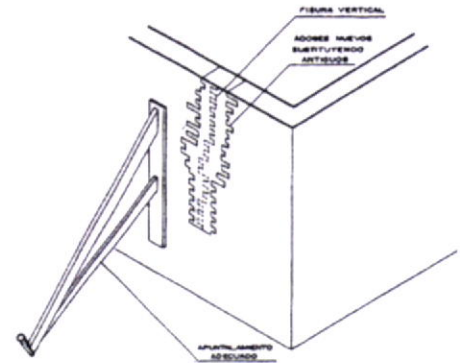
Exemplo de reparação de fissura vertical de grande dimensão.
